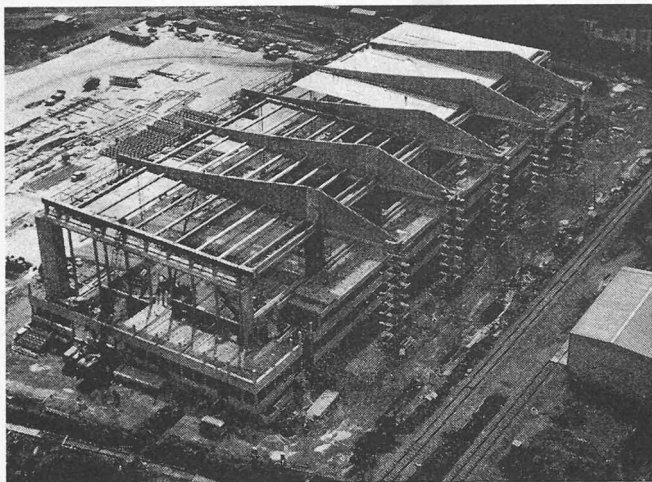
Flugzeughallen Landsberg, Hallenkonstruktion im Bau
